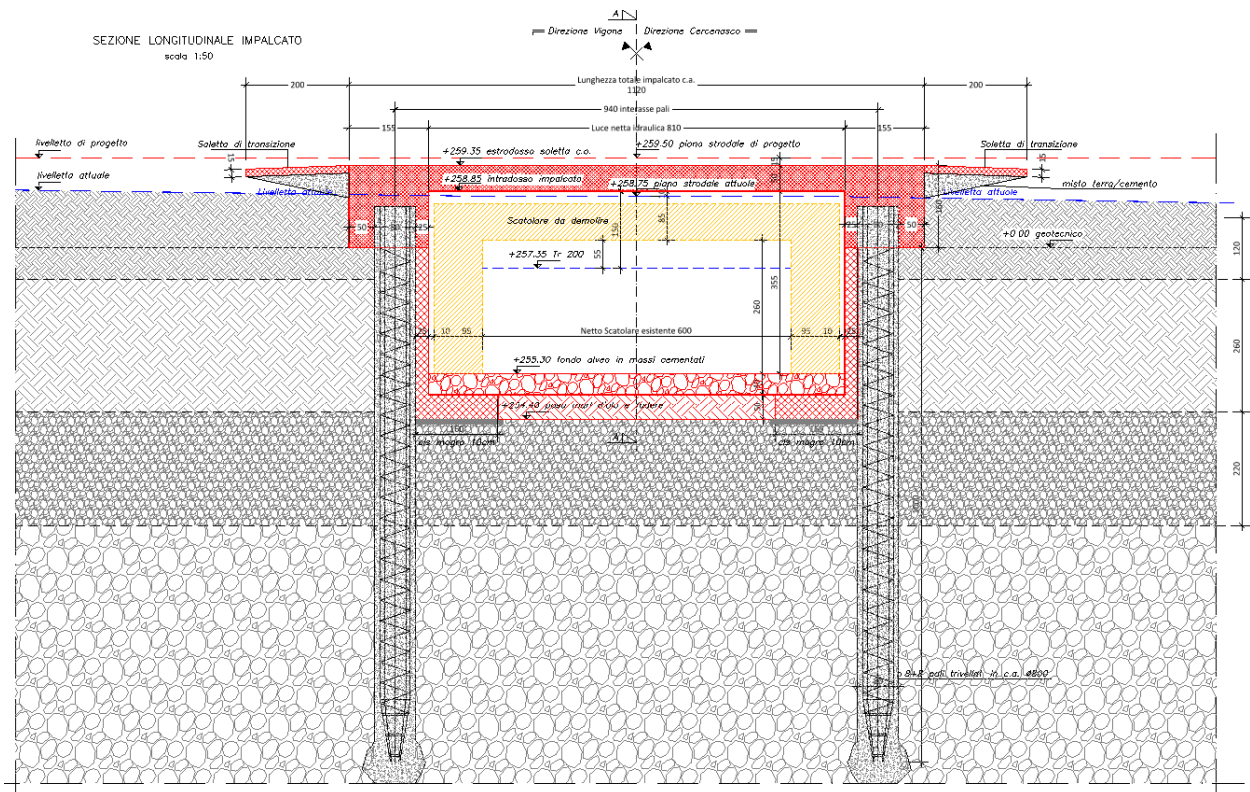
Sezioni longitudinale in asse strada nuove opere.
